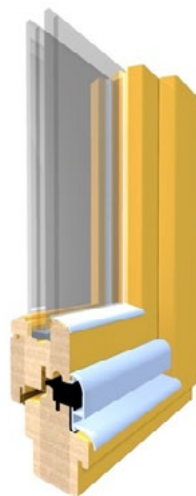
Dřevěná okna jednoduchá 68 – CADRE
